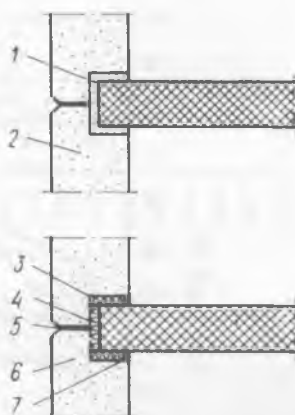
Примеры жесткого (вверху) и упругого (внизу) крепления со звукопреграждающими швами для наружной стены из ячеистого бетона и внутренней общей стены из плотного бетона
